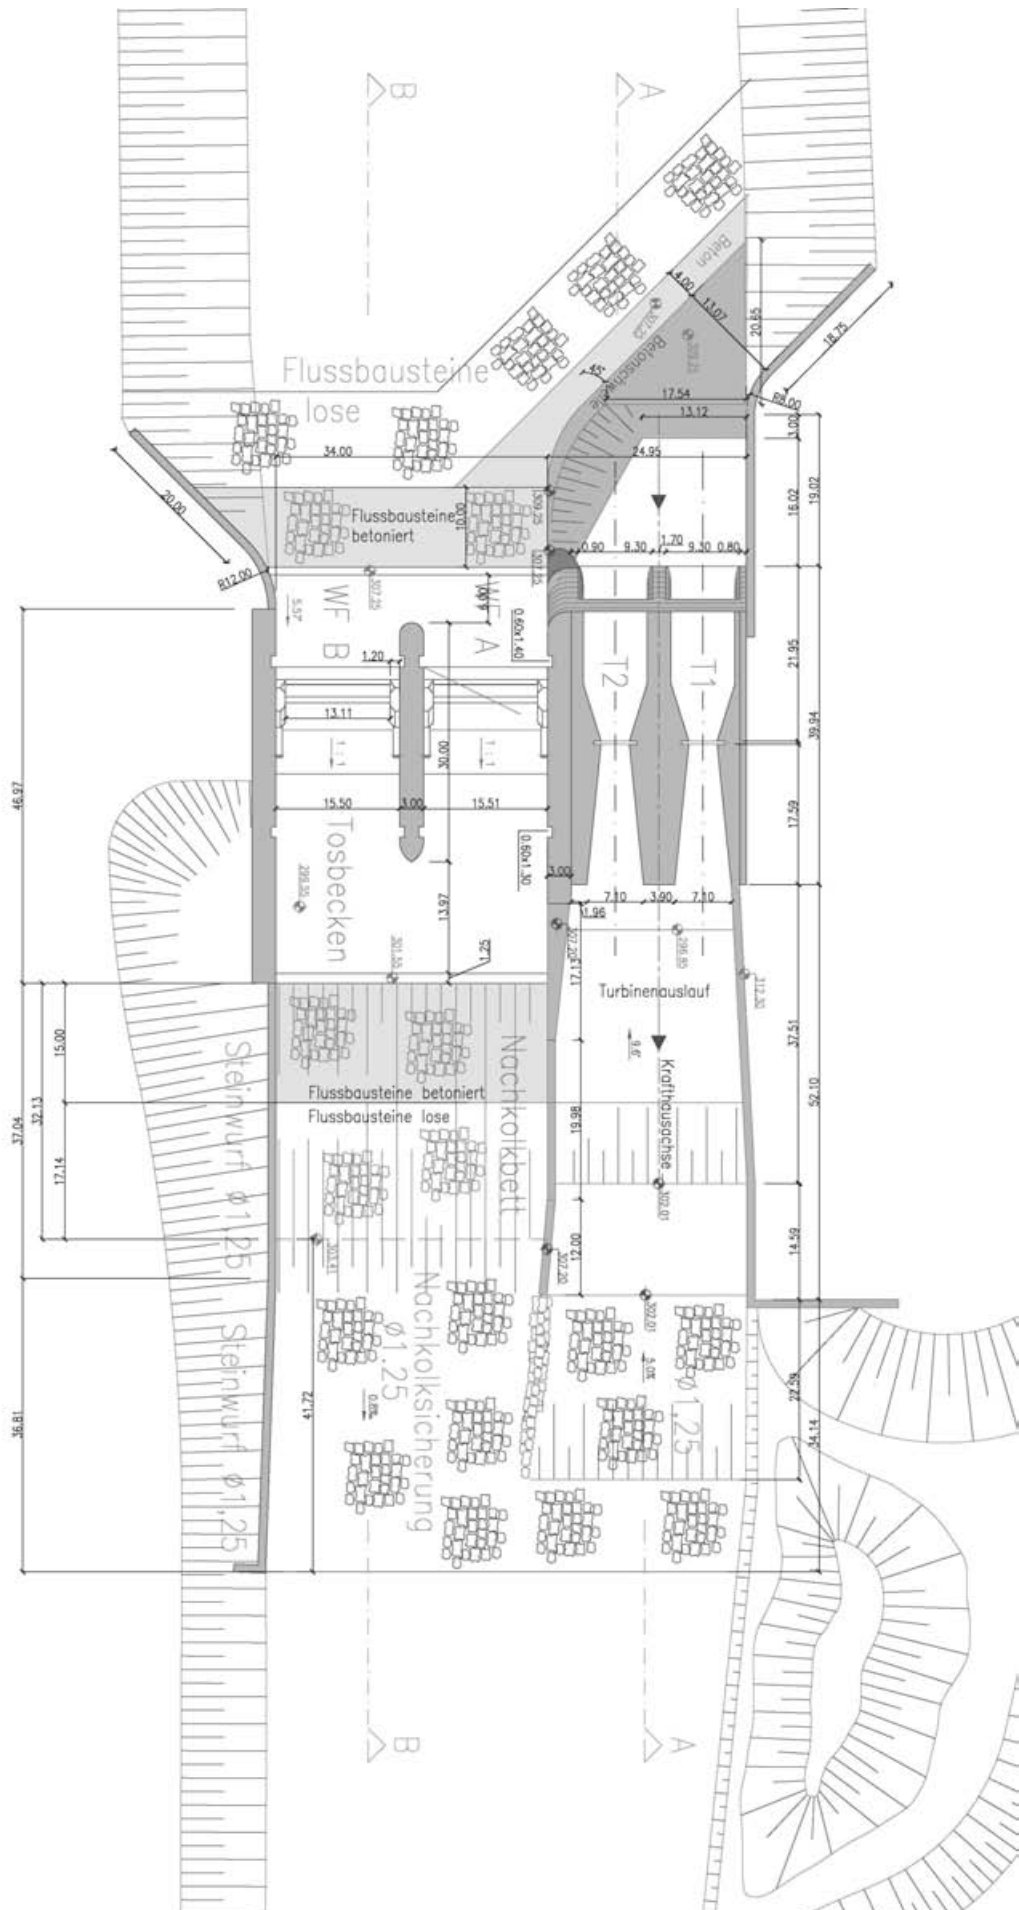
Grundriss des Modells (m-Maße : Natur)
